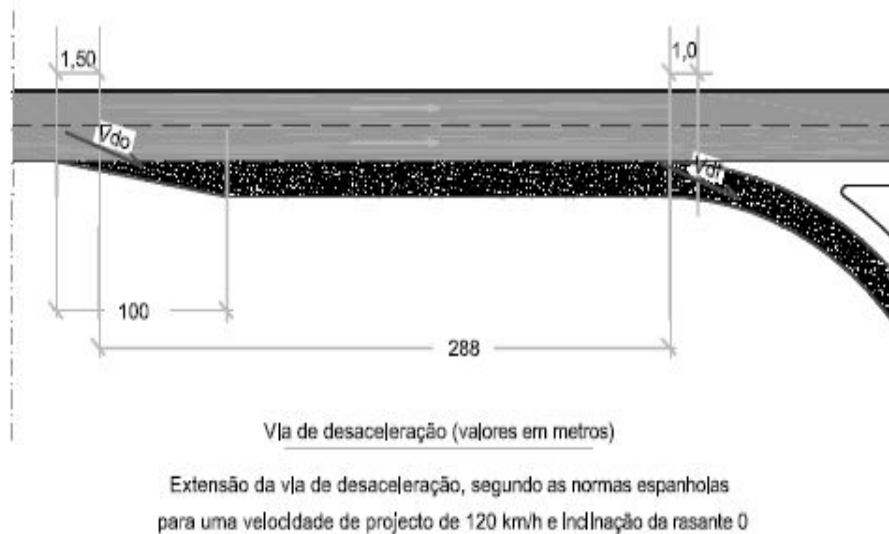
Via de desaceleração, tipo paralelo utilizada em Espanha[5]
